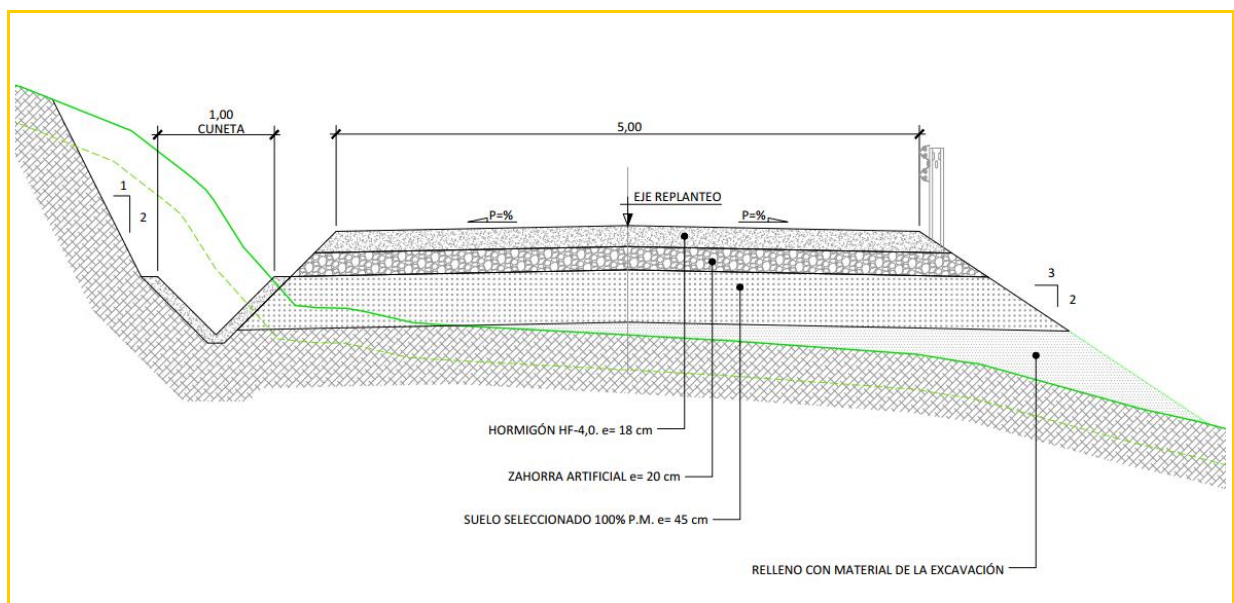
Detalle de sección tipo acceso CH Irueña.
